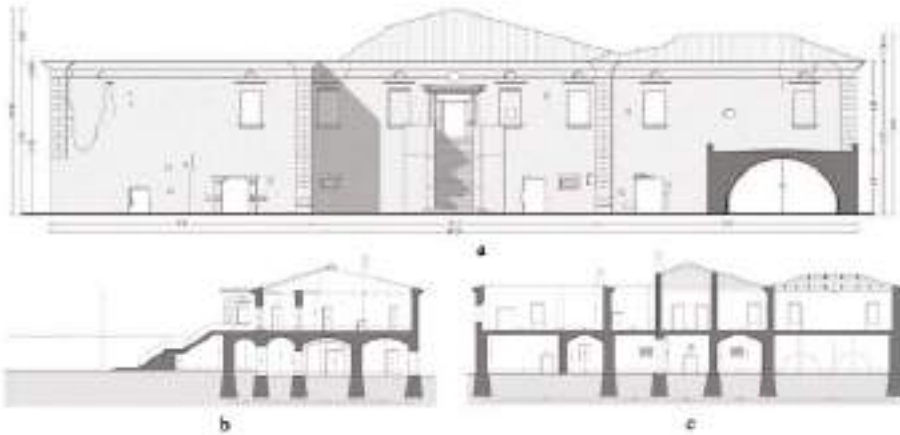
Rilievo architettonico: a) prospetto principale; b) sezione longitudinale; c) sezione trasversale
